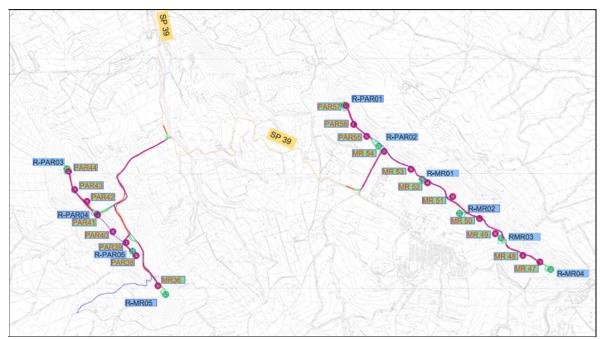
sovrapposizione del layout impianto esistente con layout impianto potenziato
